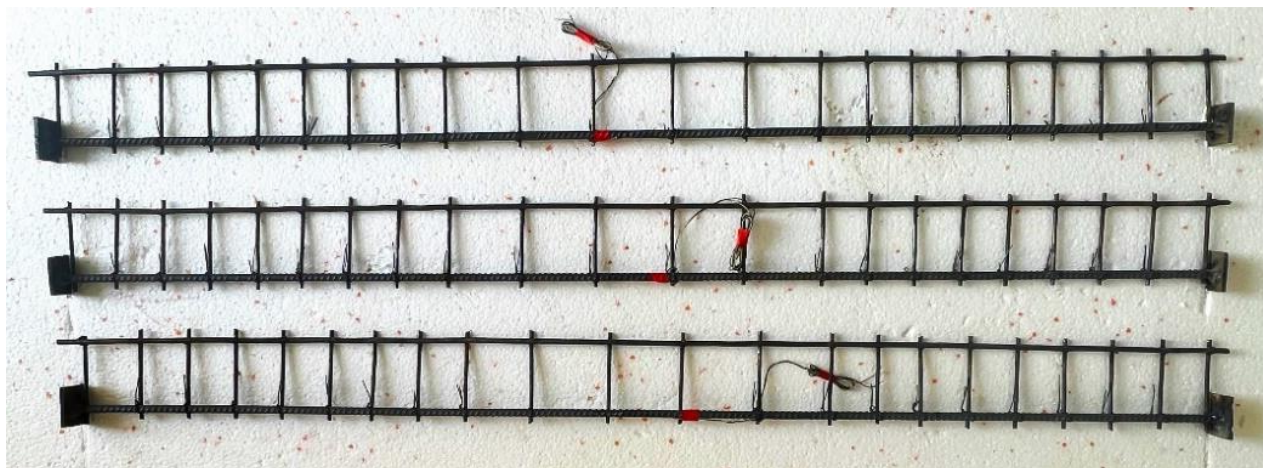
Арматурный каркас моделей железобетонных балок
